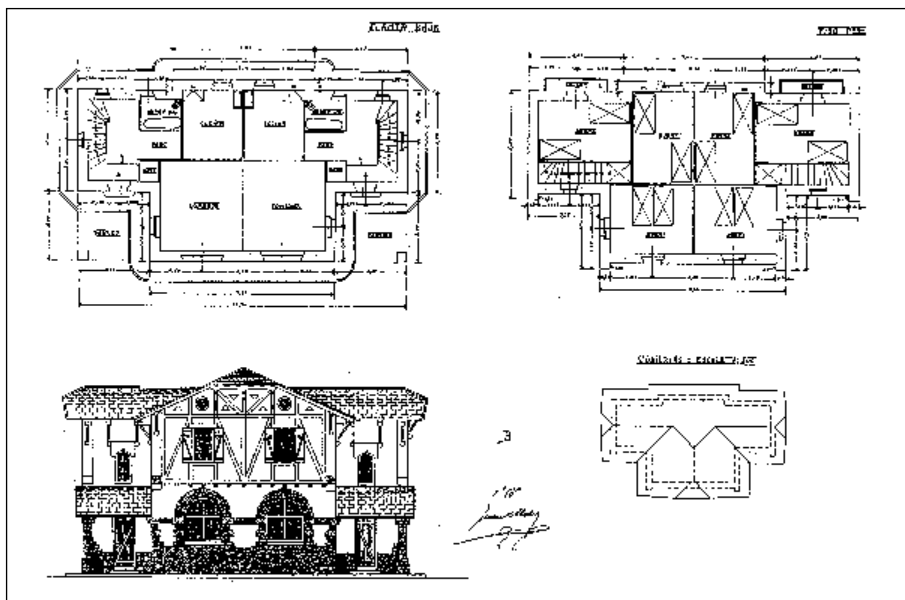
Planos de la villa C. Arquitecto José Ángel Fernández de Casadevante.
